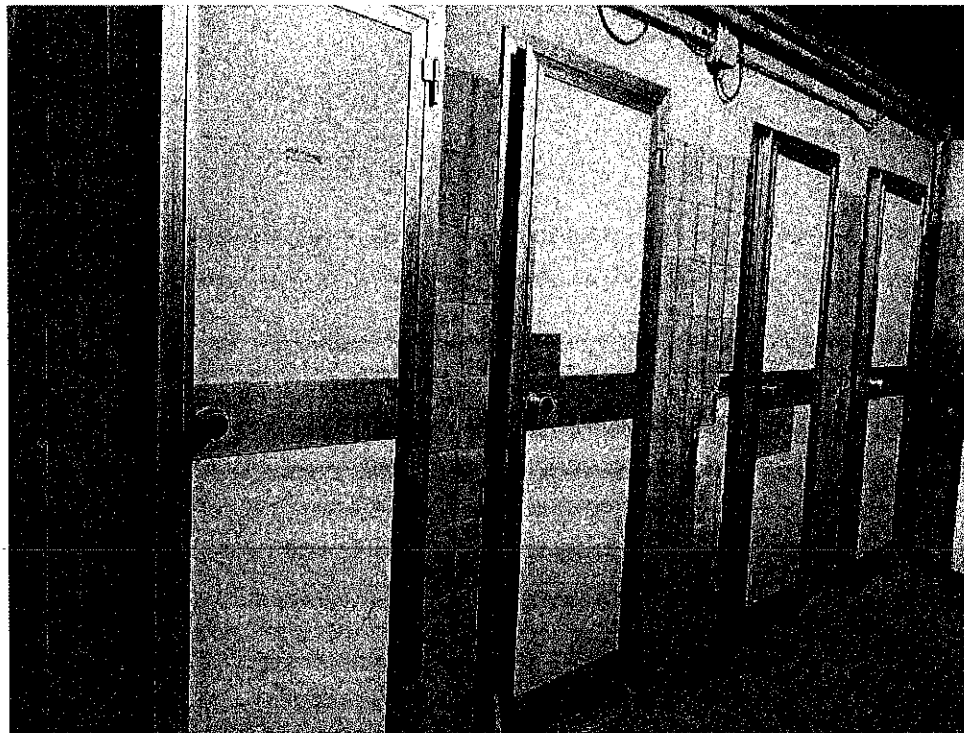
Zona spogliatoi e servizi (piano terra)
